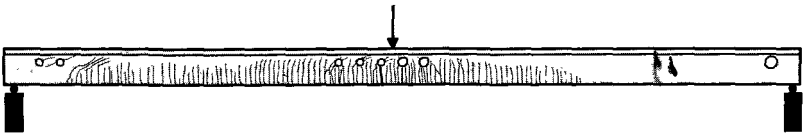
Rissbild Balken G15 nach dem anschließenden Biege- und Torsionsversuch
